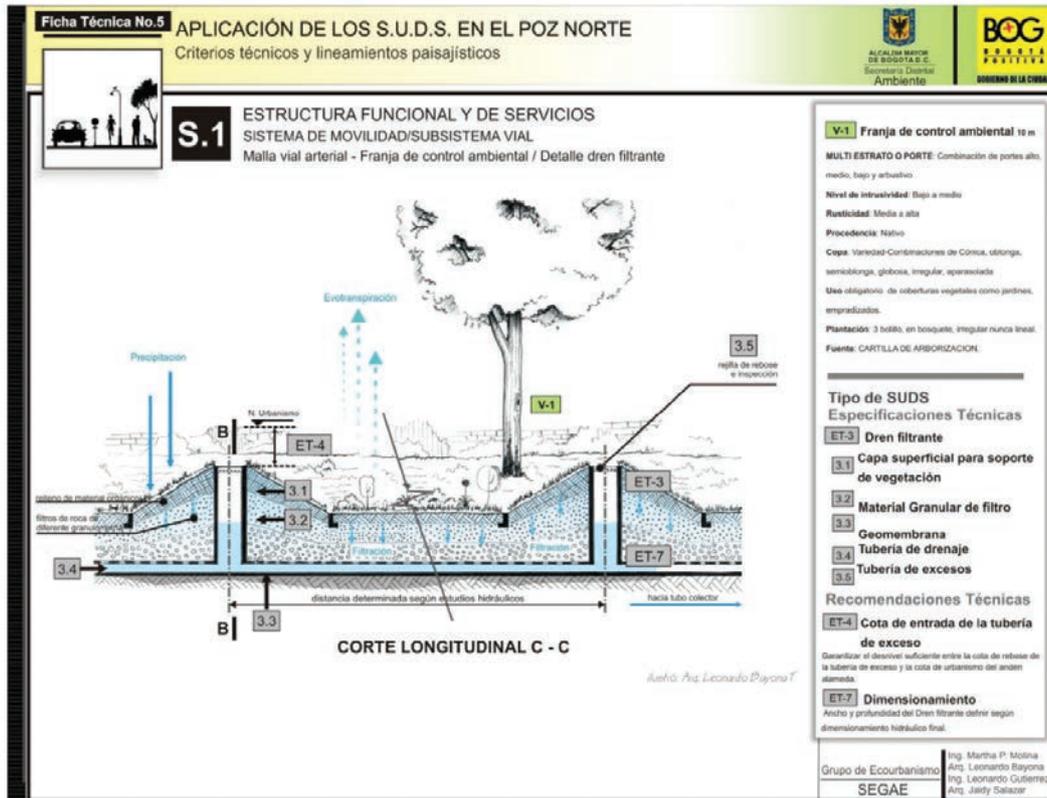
Aplicación de los S.U.D.S. Detalle Dren Filtrante - Corte general.
